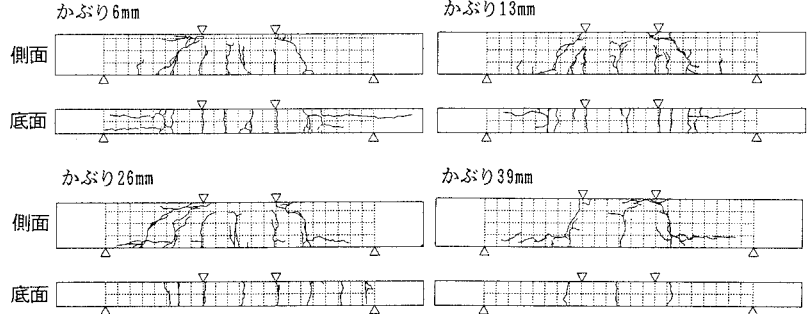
アラミド繊維を用いたはりのひび割れ発生状況
